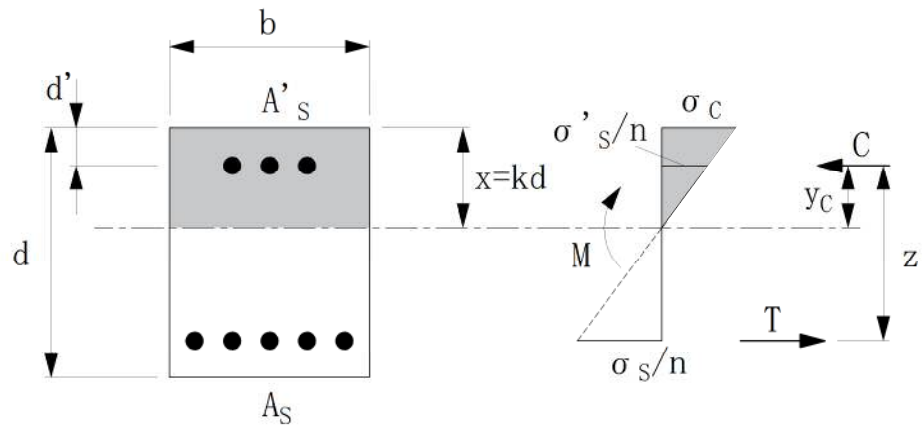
2軸複鉄筋断面の鉄筋コンクリート断面
